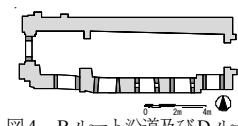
Bルート沿道及びDルート伽藍内の宿駅の平面図
